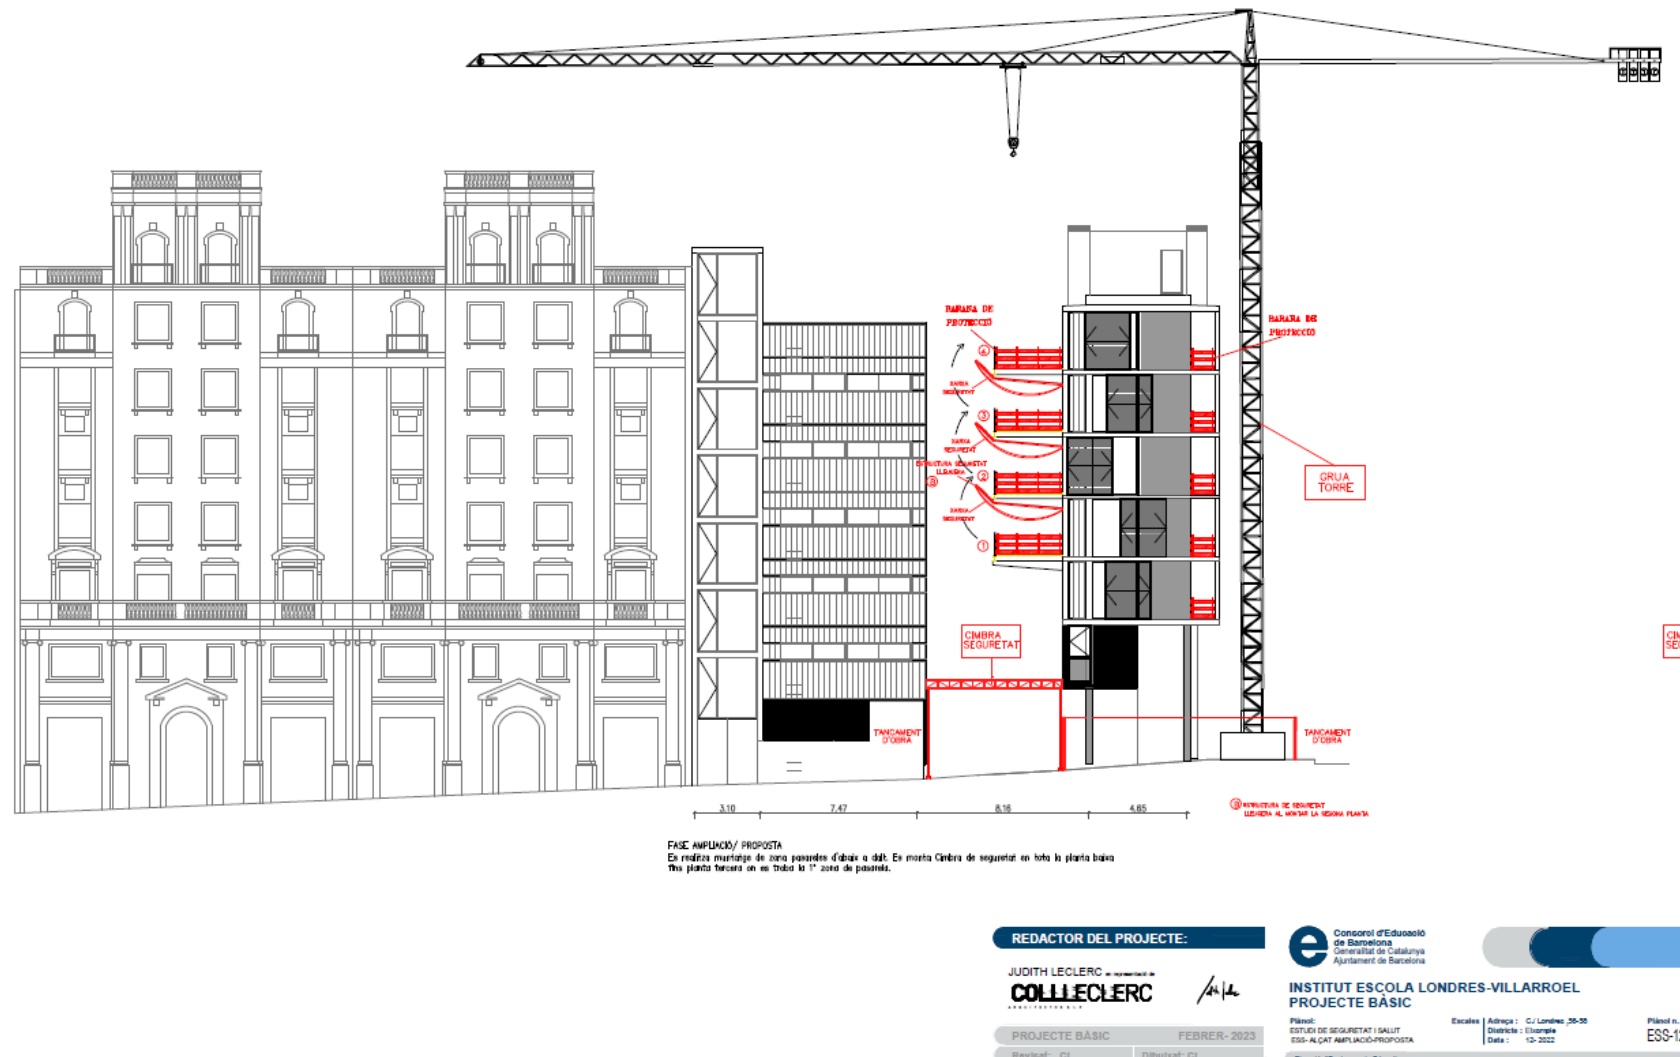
Organització de les obres. Perfil des del C/Villarroel. Es munta cimbra de seguretat en tota la planta baixa fins a la tercera planta, on es troba la primera zona de passarel·la. Font: Projecte executiu.
